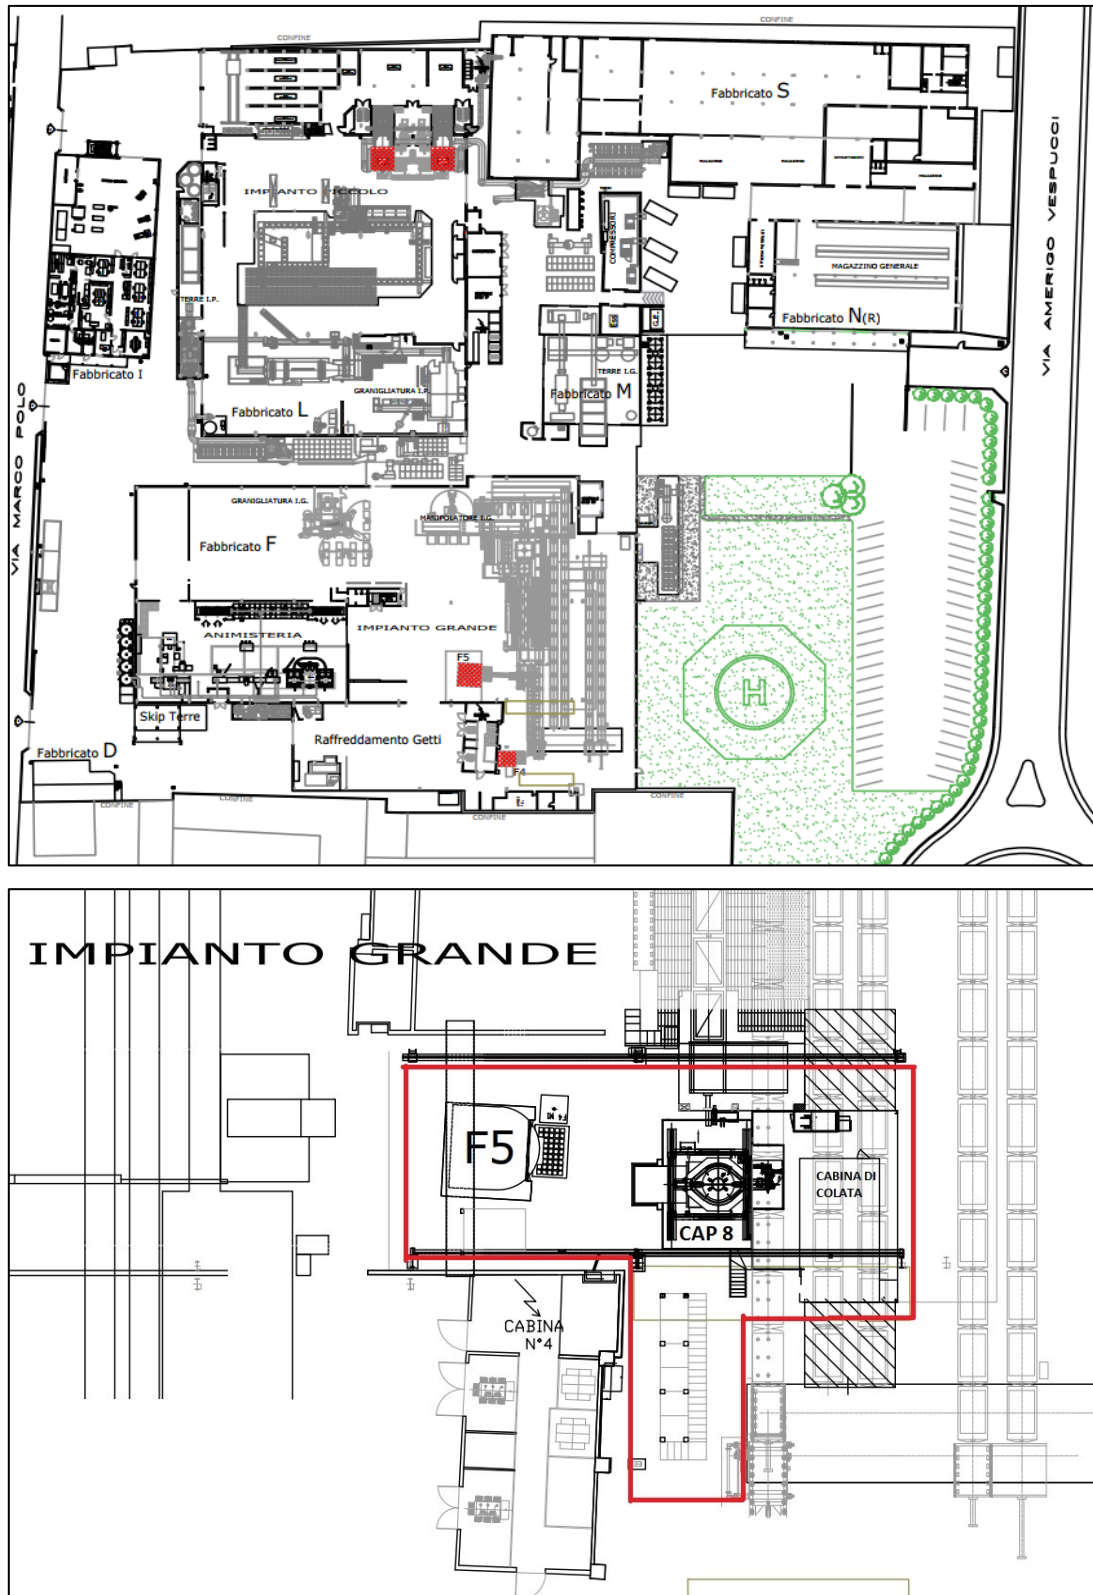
e 32: Planimetria generale impianti produttivi (sopra), particolare dell'area di colata (sotto)
